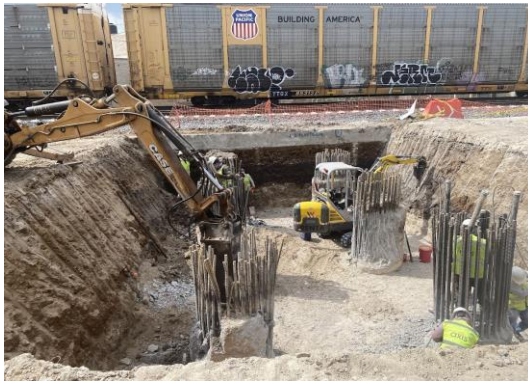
y 96 Autoría Propia (2023) "Vista de trabajos de excavación, sistema de contención de pilas secantes y traves de liga en ambos lados"
